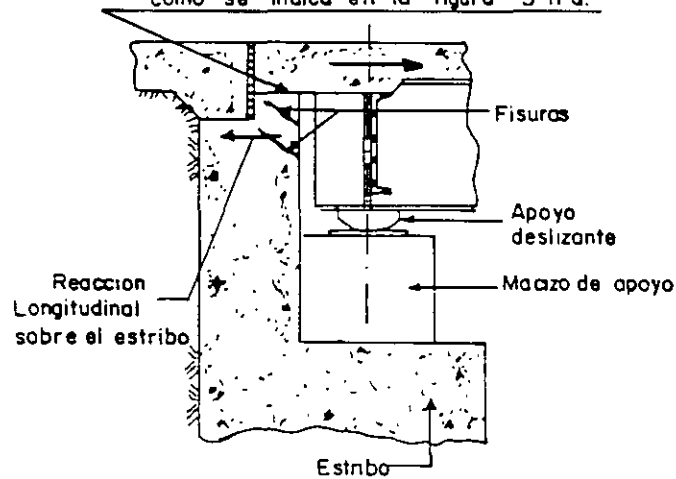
FIG II - IIb - Fisuración del apoyo del tablero
